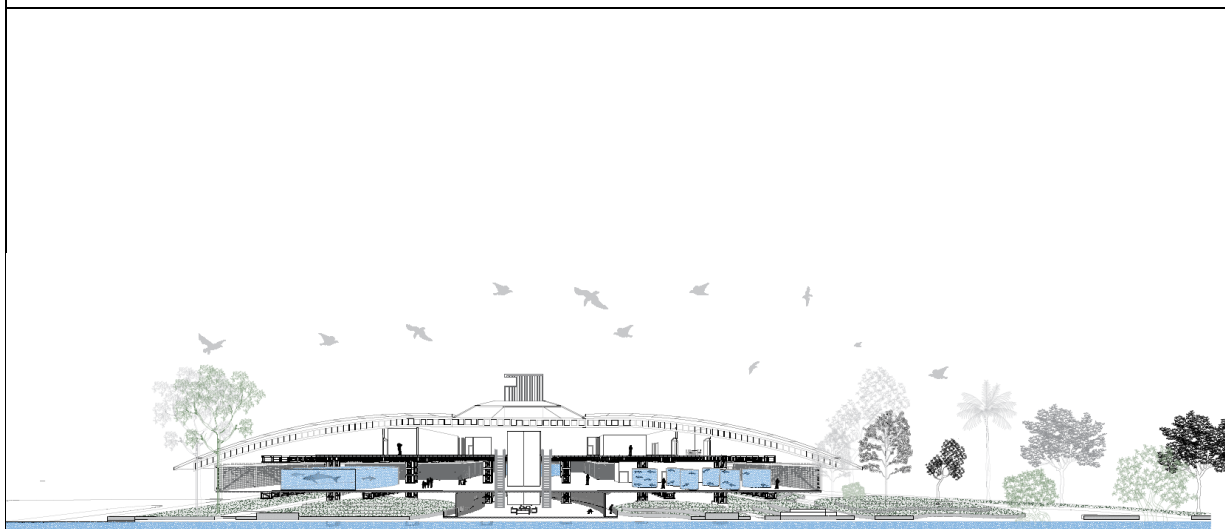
Corte fugado transversal. Fuente: Elaboración Propia
